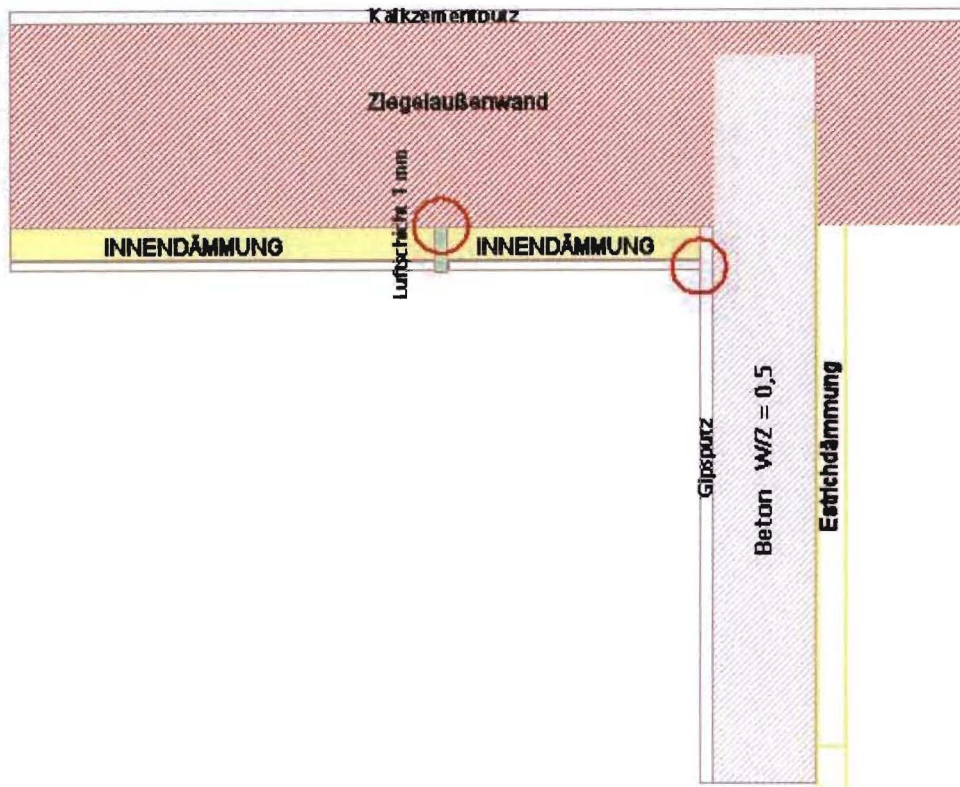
Implementierter Wandaufbau mit einer Betondecke, die oberseitig mit einer Estrichdämmung versehen ist.
